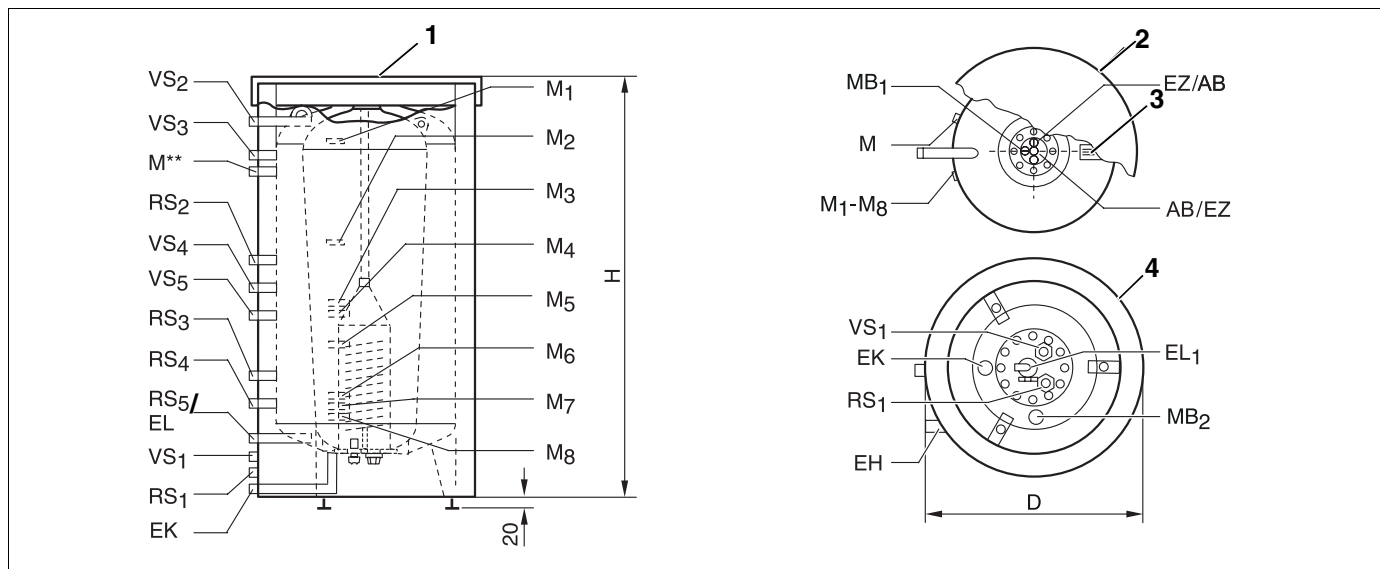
Vue latérale, vue de dessus, vue de dessous
